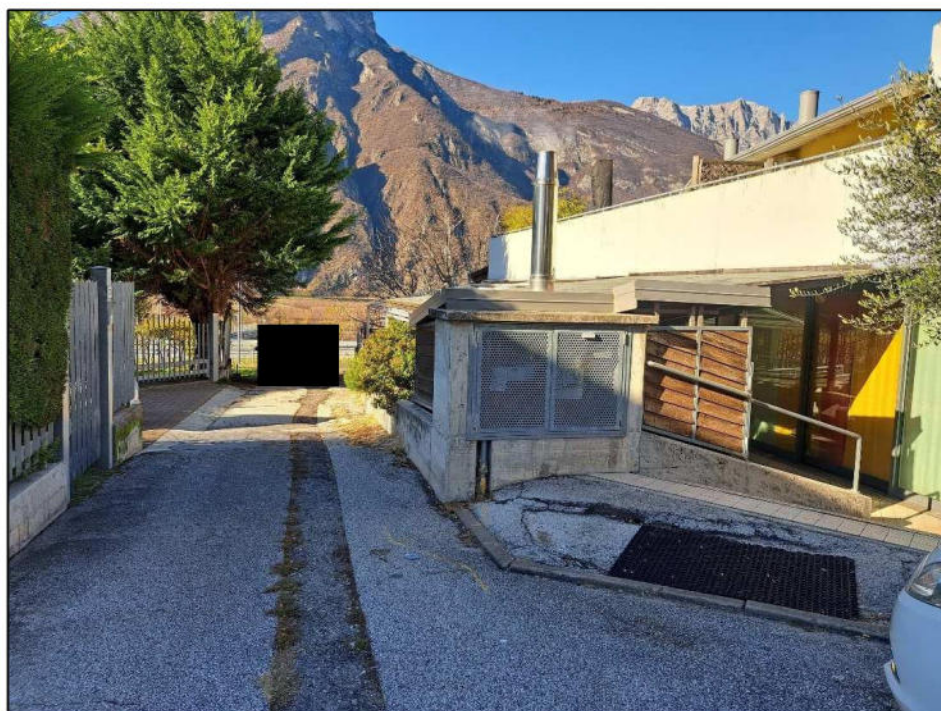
consortale p.f. 1488/2, confine sud con la p.ed. 918 – presa da est.
